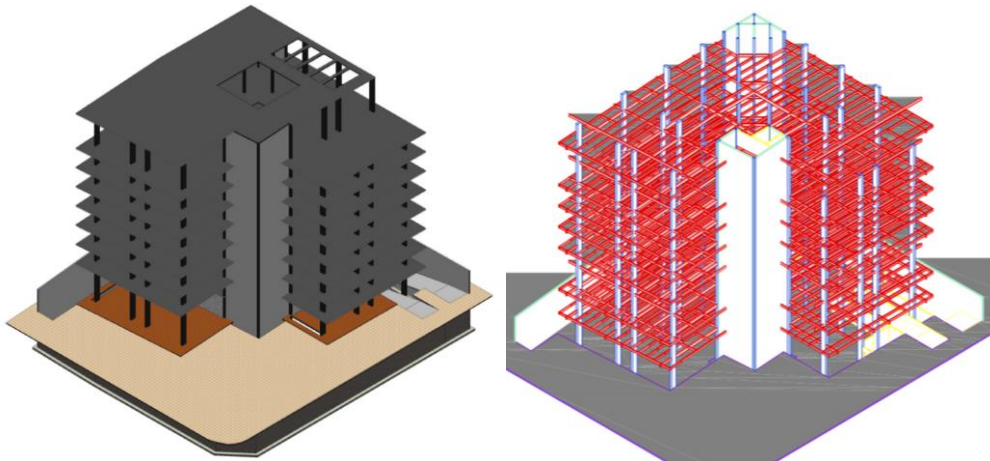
Sistema estructural del edificio. Elaboración propia, 2019.
